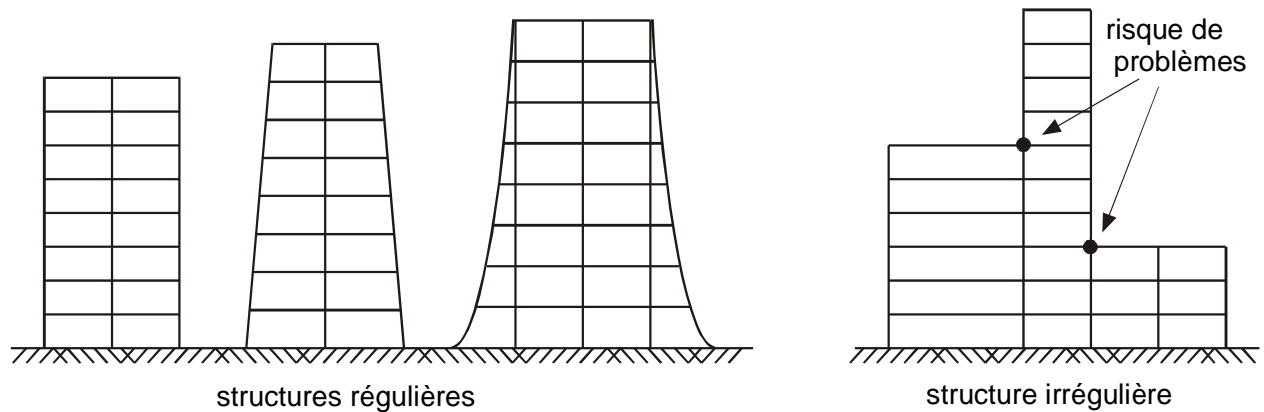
Application du principe de simplicité et continuité aux plans d'élévation
